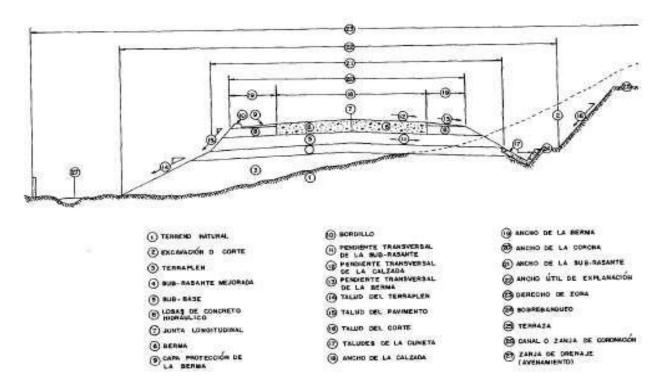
SECCION TIPICA DE UN PAVIMENTO RIGIDO
